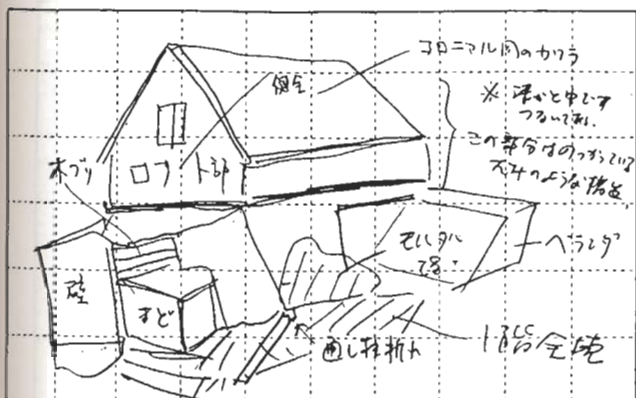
No.25-3階建て住宅(東灘区本山中町)
